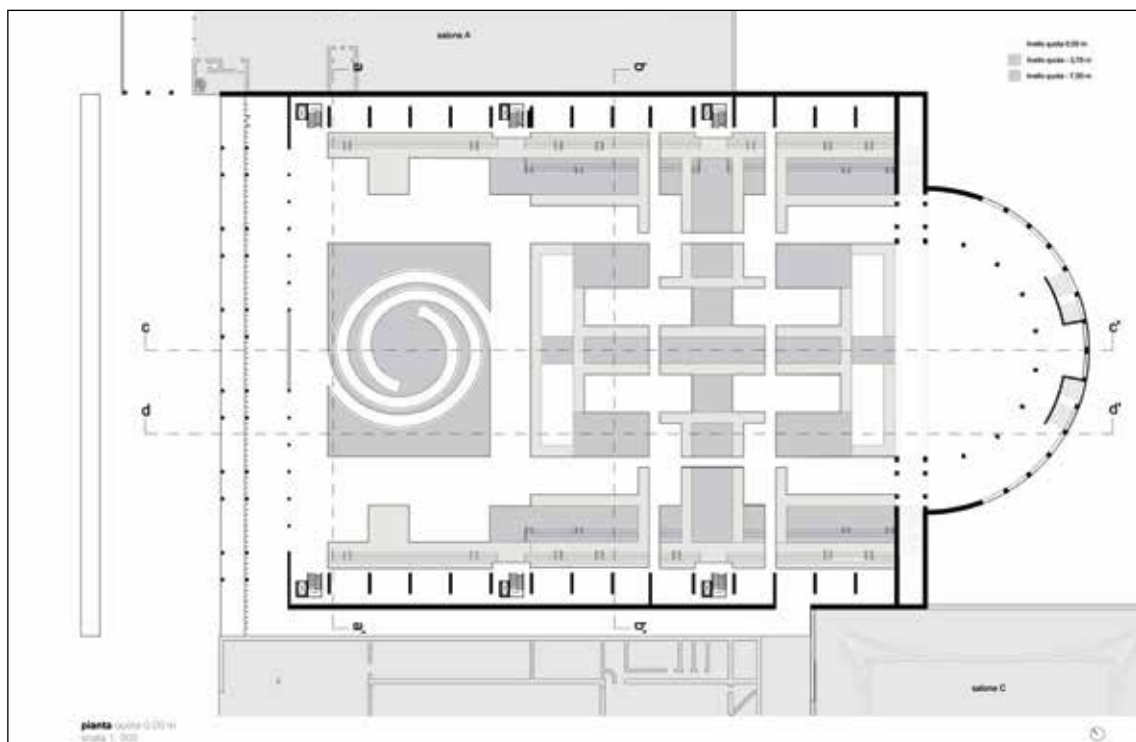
Progetto di Sarah Becchio: pianta del piano terra con le corti ricavate al livello interrato.
